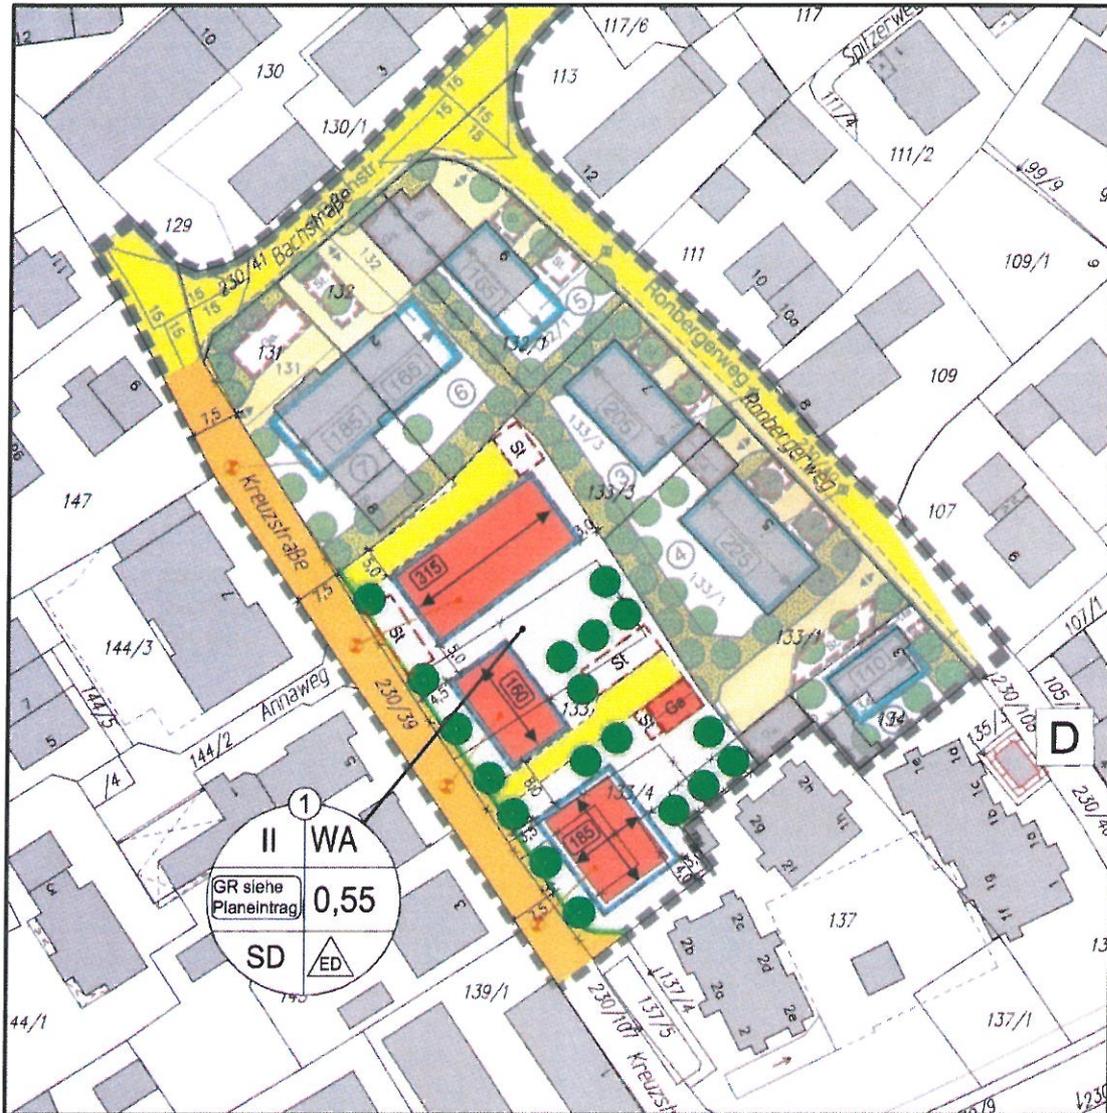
Bebauungsplan "Kreuzstr.-Ronbergerweg" Synopsenplan mit zeichnerischen 1. Änderungen
